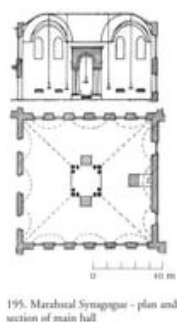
Grundriss und Schnitt der Maraszal Synagoge
